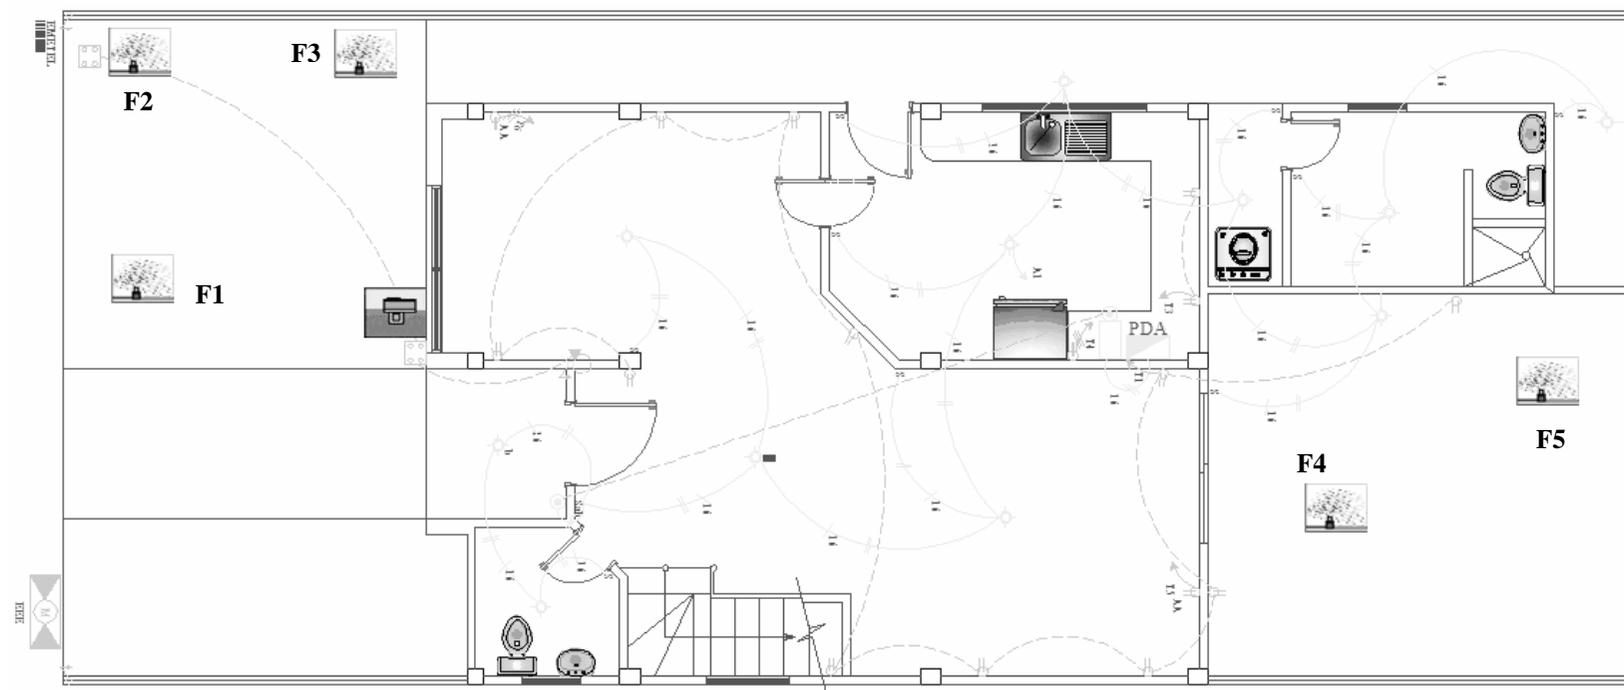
Sistema de Riego, Planta Baja, Plano Eléctrico.
